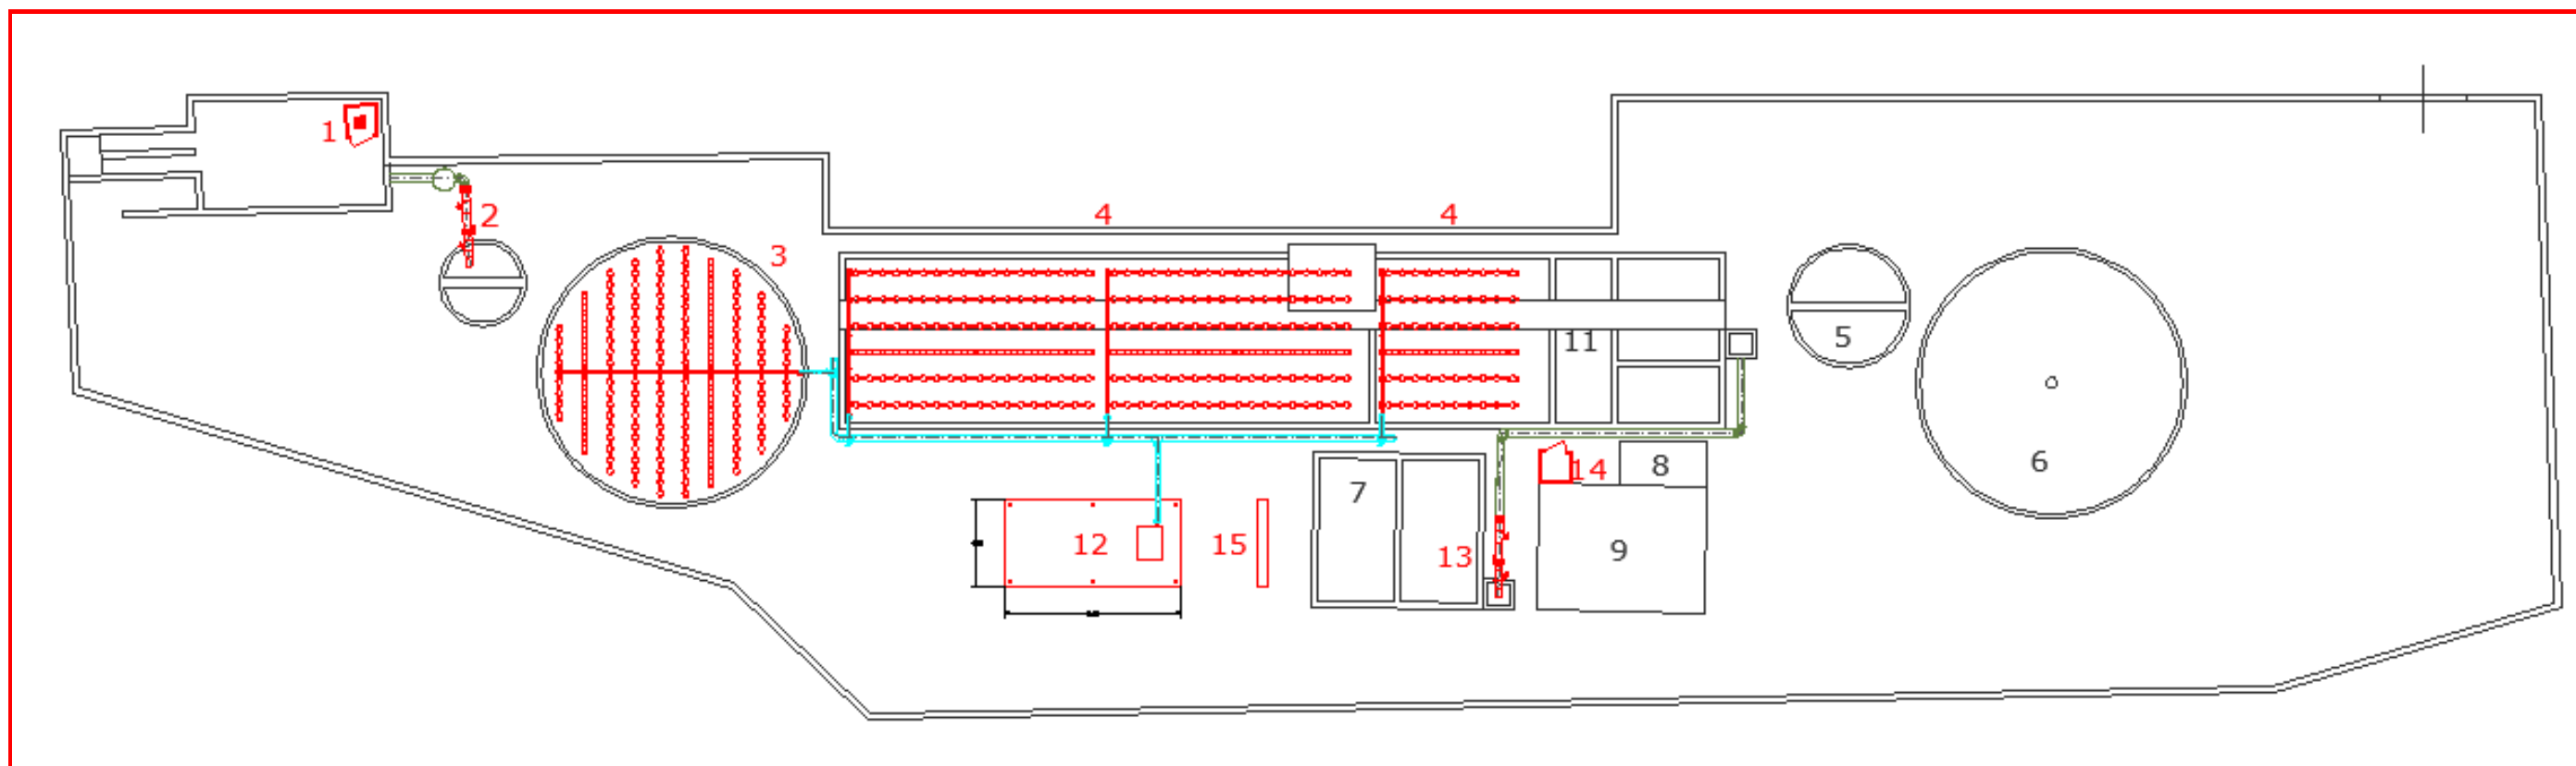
Planimetria Generale dell'impianto con evidenziate le aree d'intervento
